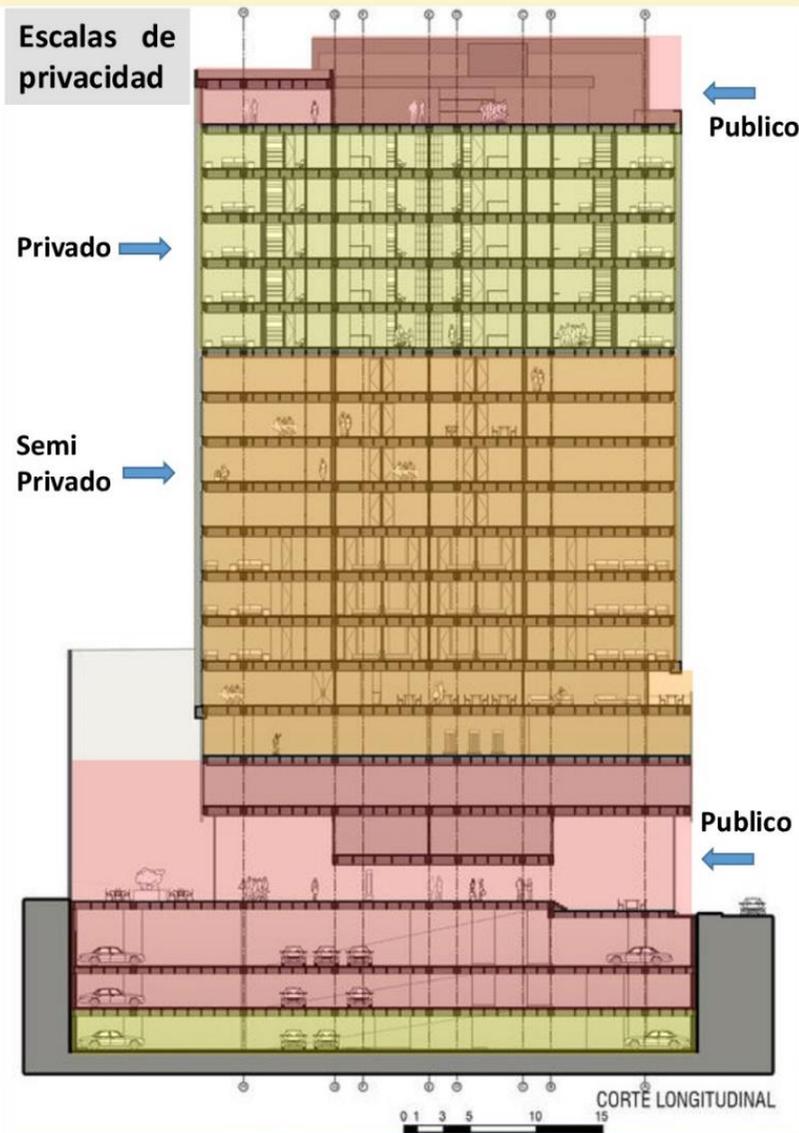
Corte longitudinal escala 1:300 Fuente: www.archdaily.pe
